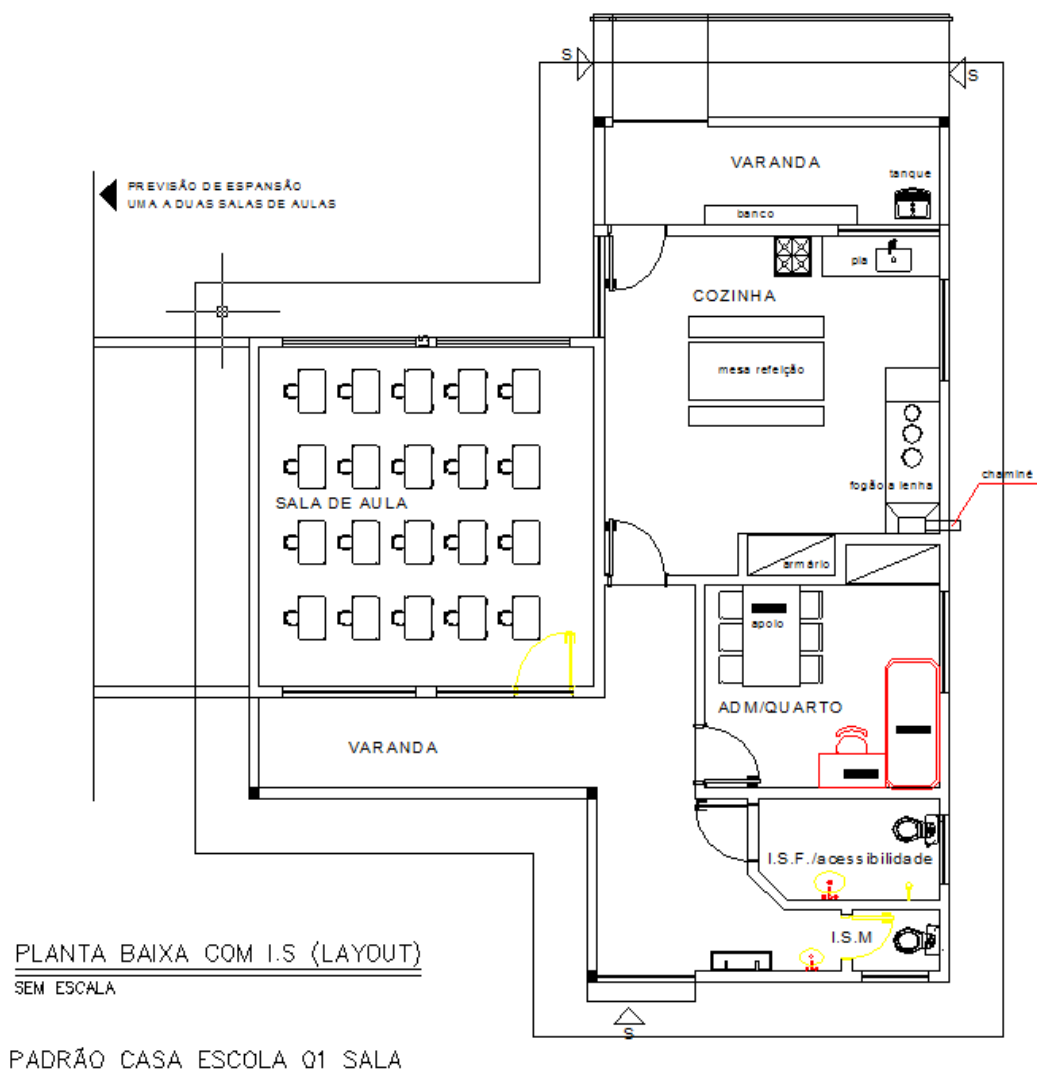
Planta do Projeto “Casa Escola” com 01 sala.
